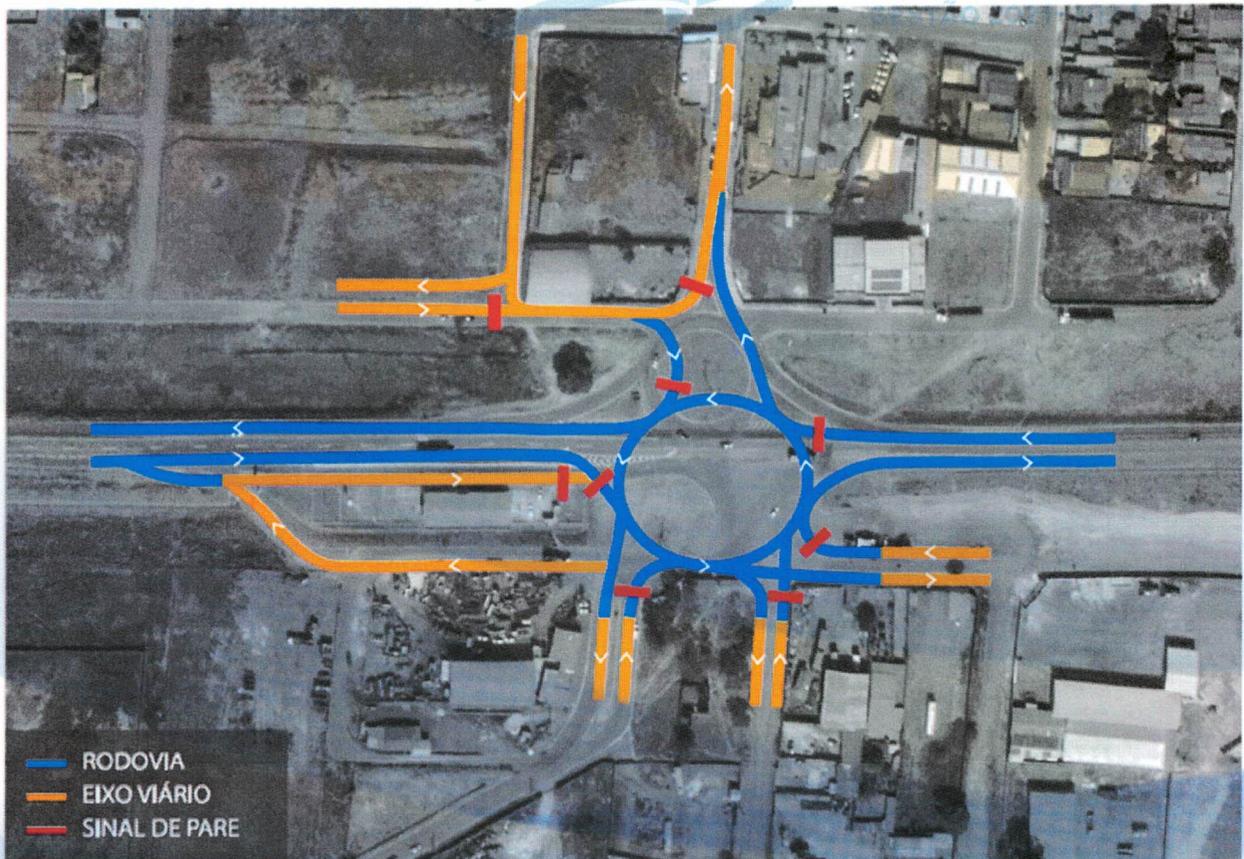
Esquema da solução proposta para o dispositivo no acesso ao Bairro Cristal.
